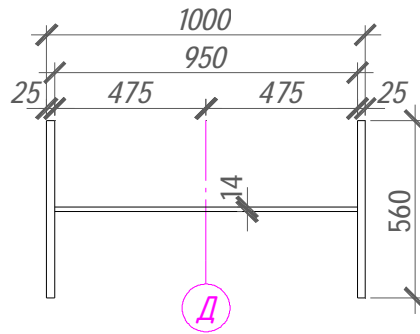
Поперечное сечение надкрановой части колонны по оси «Д» в отметках 20÷32 м.
